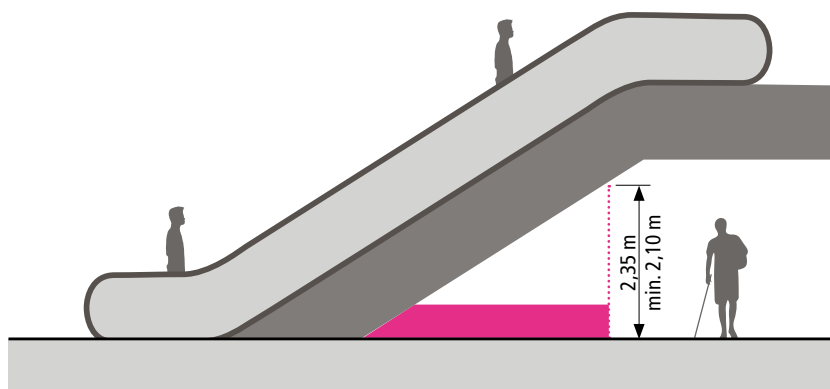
Sécurisation d'un endroit où la hauteur libre est trop basse (source : SN 640 070)
